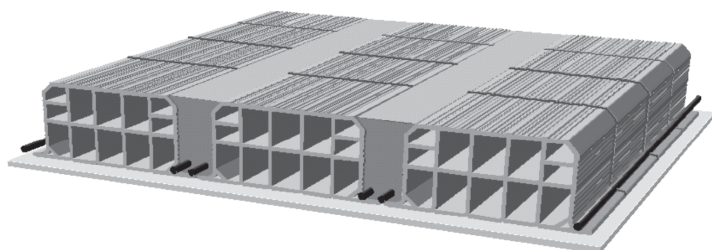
Esempio di solaio in calcestruzzo armato e blocchi di laterizio con travetti gettati in opera¹
